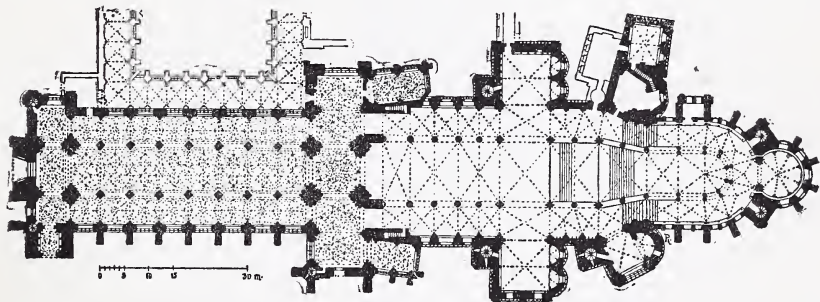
Grundriss der Kathedrale von Canterbury.
